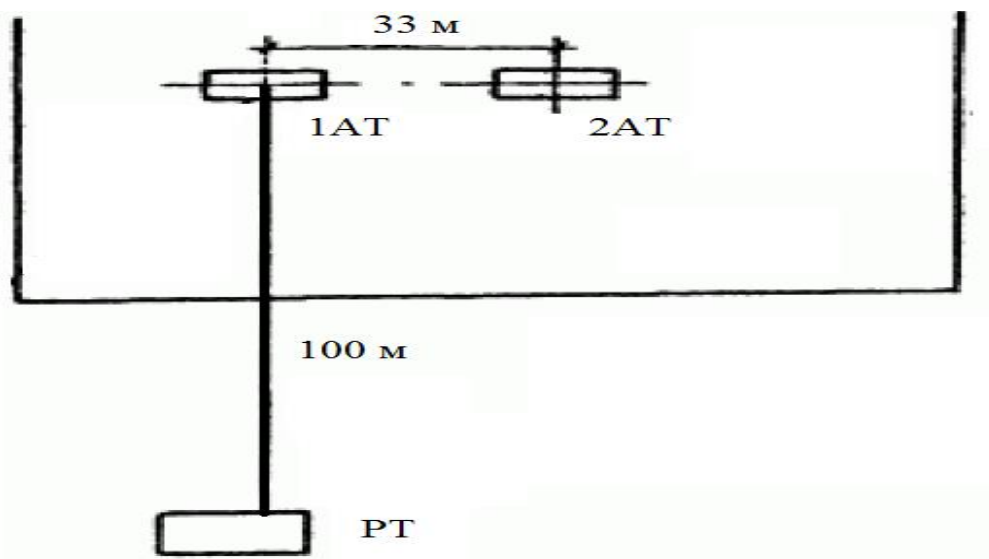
План расположения площадки ПС и АТ относительно застройки
